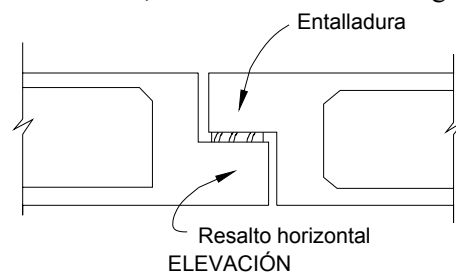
Simbología y ubicación de las potenciales fisuras para los resaltos horizontales tipo viga
